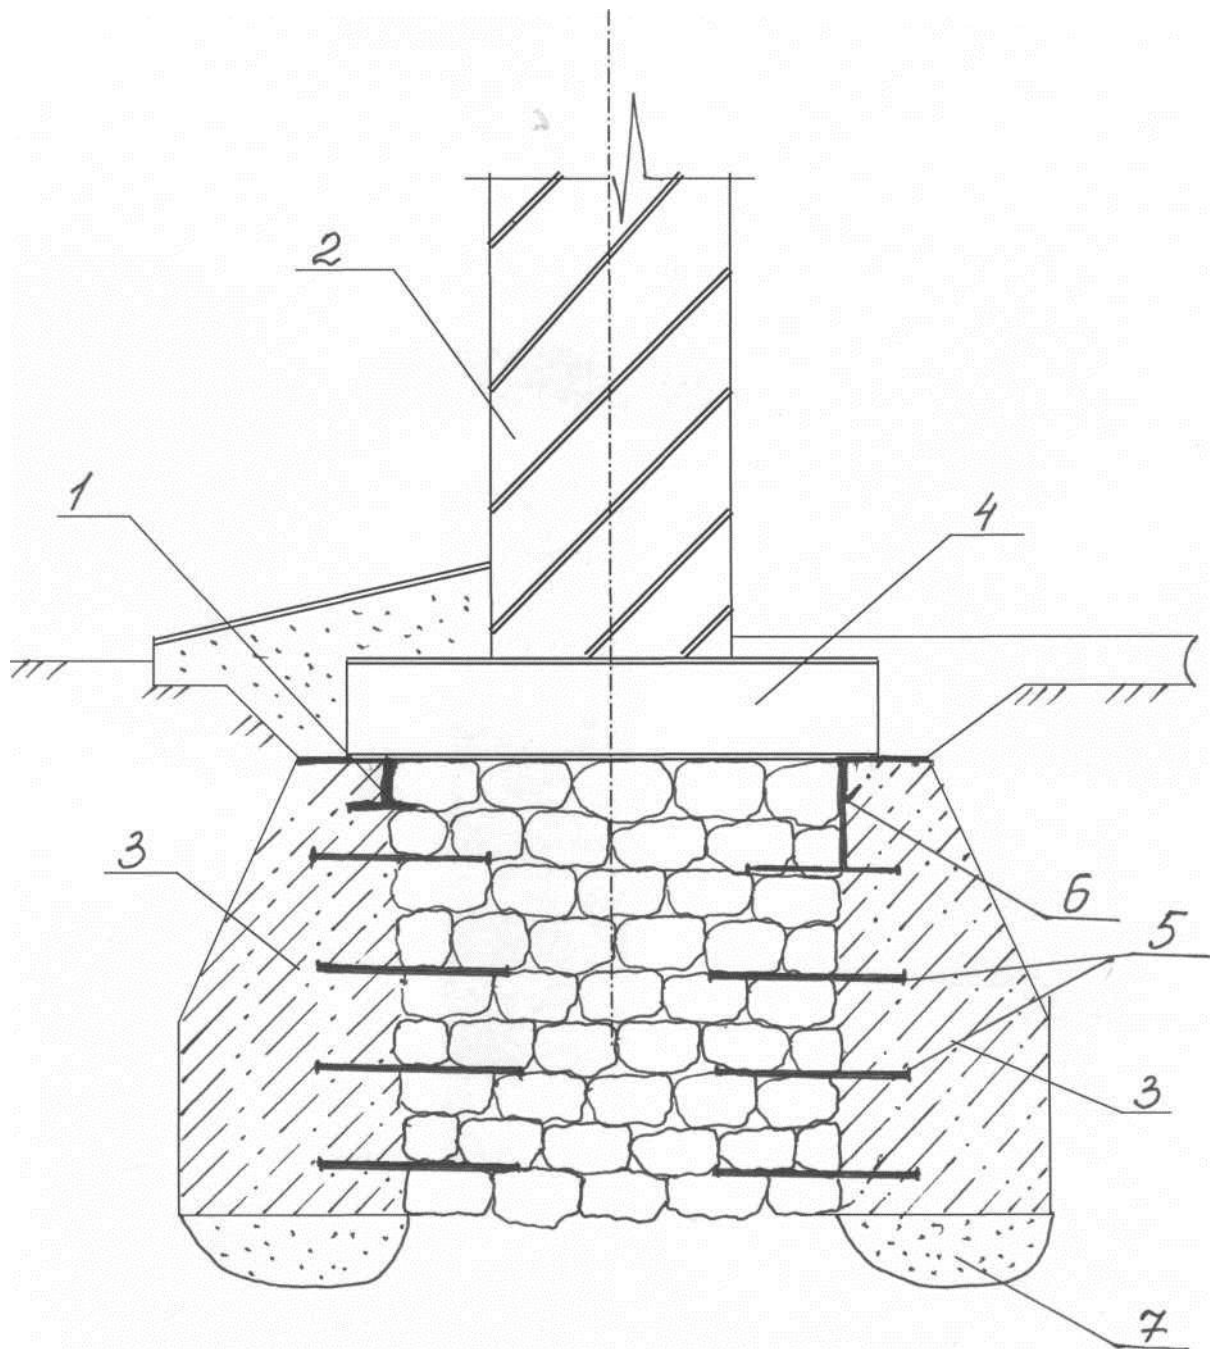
Уширение опорной площади устройством приливов из бетона
